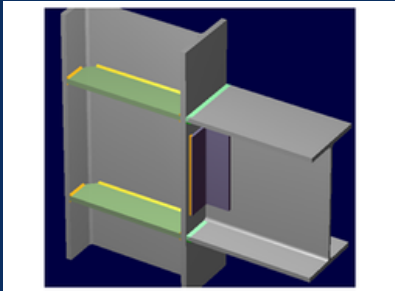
Tomada de Software RAMI Connection para hacer este tipo de conexión en una estructura es necesaria la aplicación de soldadura en los patines superior e inferior de la viga. Toda esta soldadura se tendría que aplicar en campo.
